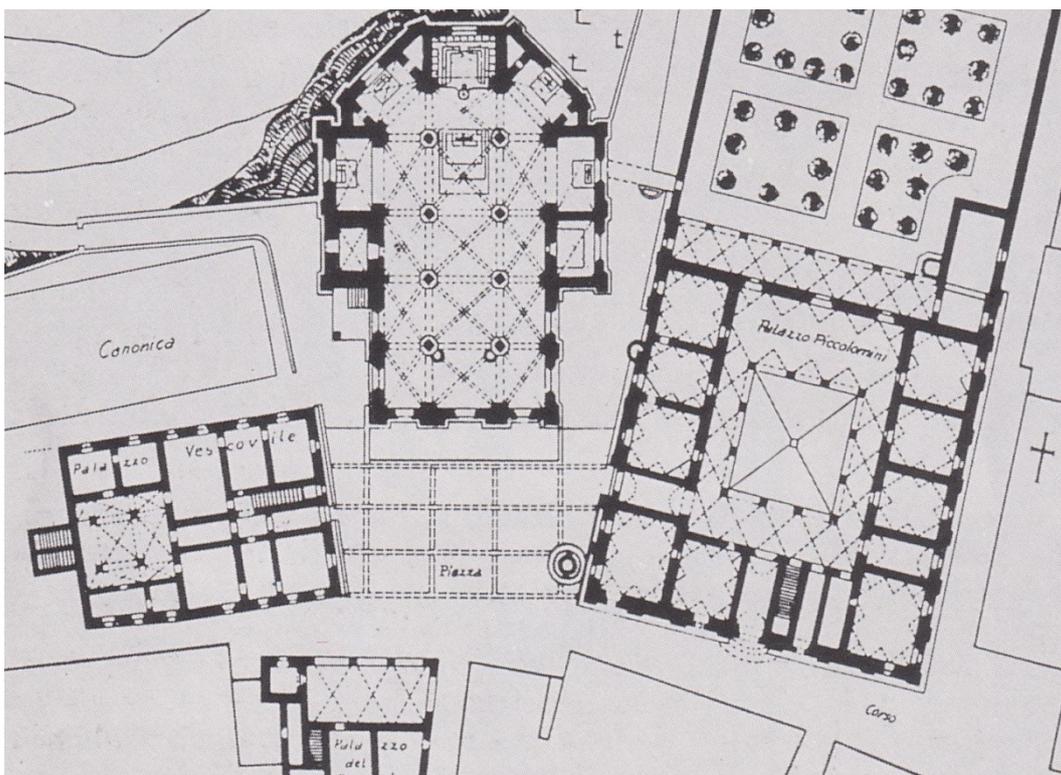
Anonym: Grundriss der Piazza Pio II in Pienza, o.J., o.A
